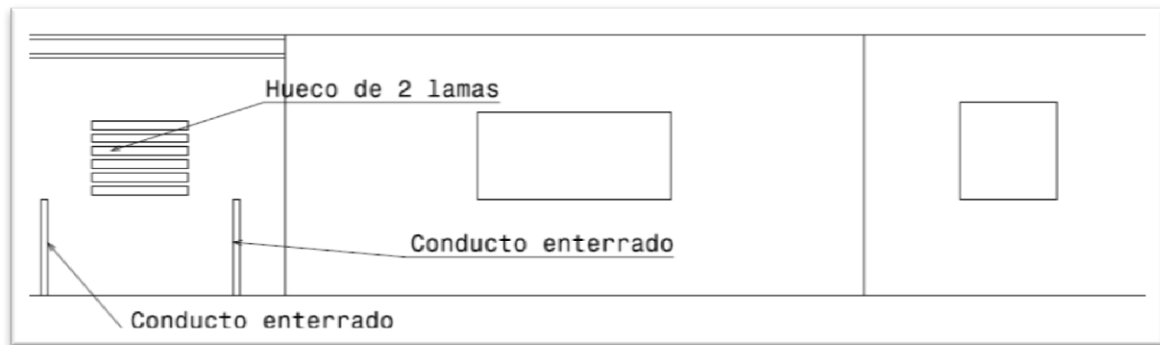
Disposición de muros Trombe y solar en fachada sur.
